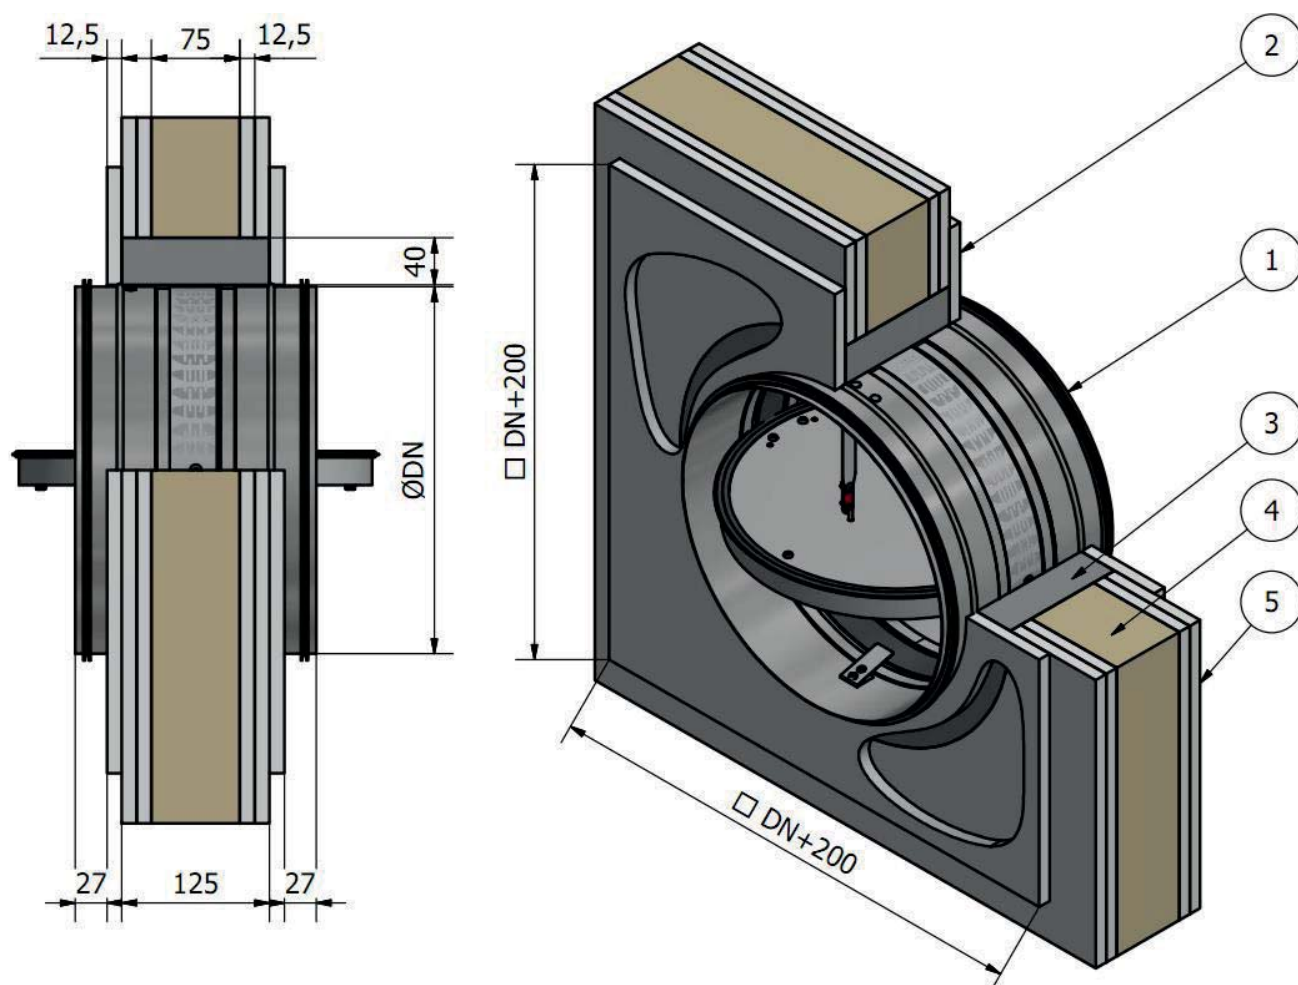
Montering av FDA-12-M-spjället i betongtak.
